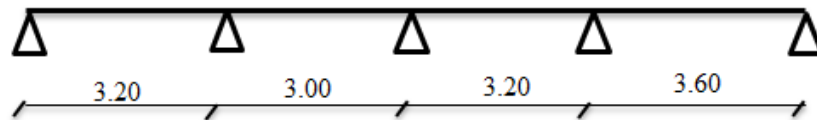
Poutrelle type 01 (Plancher terrasse inaccessible)
